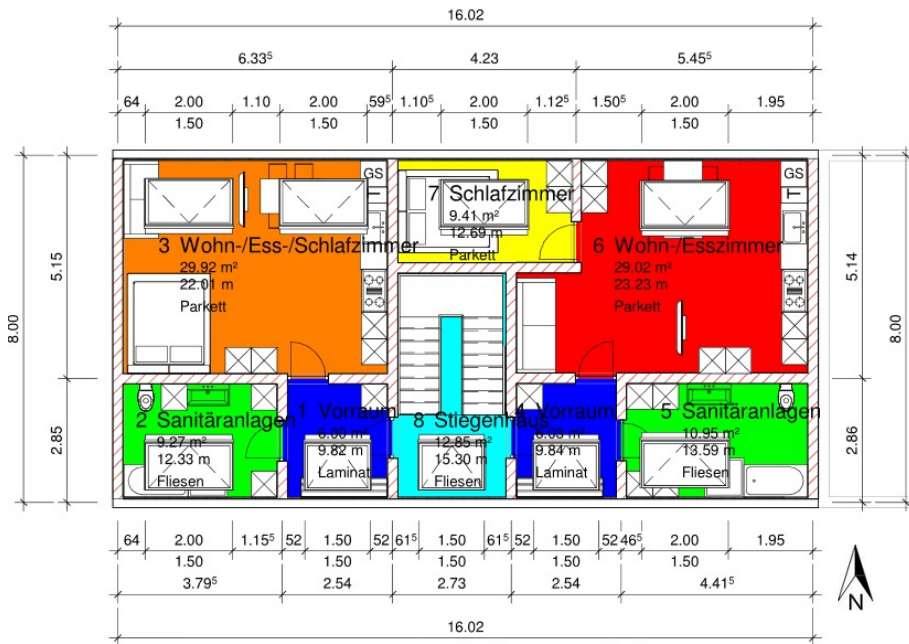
DG Ausbau – Grundriss DG
